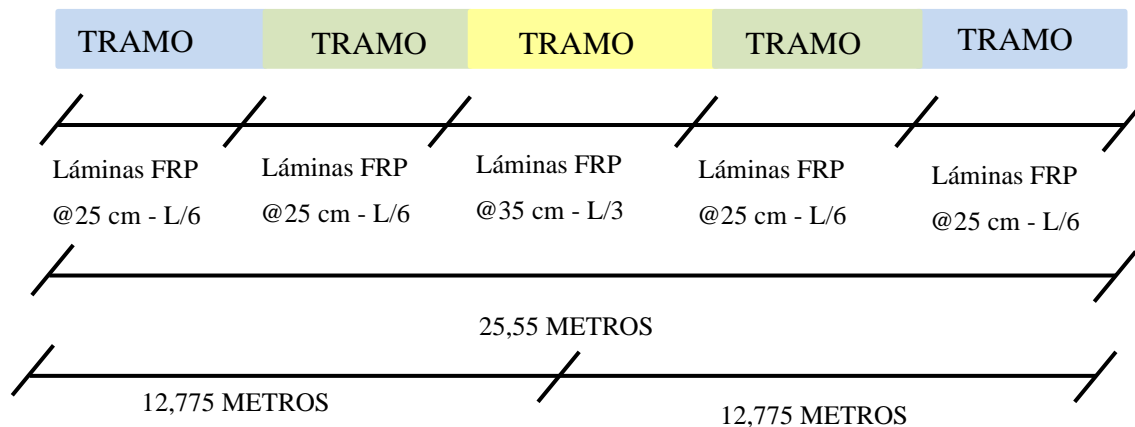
Esquema reforzamiento viga a cortante para la viga Tipo 2 (L=25.55m) (elaboración propia).
